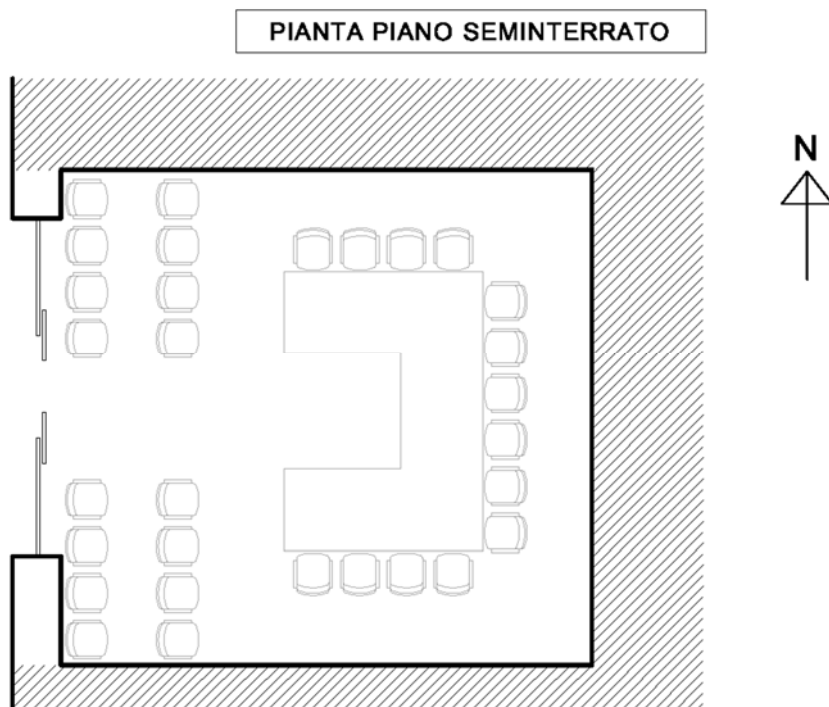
Sede Municipale: pianta piano seminterrato
